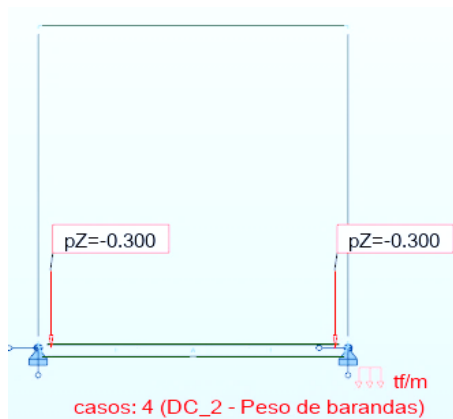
Disposición de carga debido al peso de parapeto y barandas
